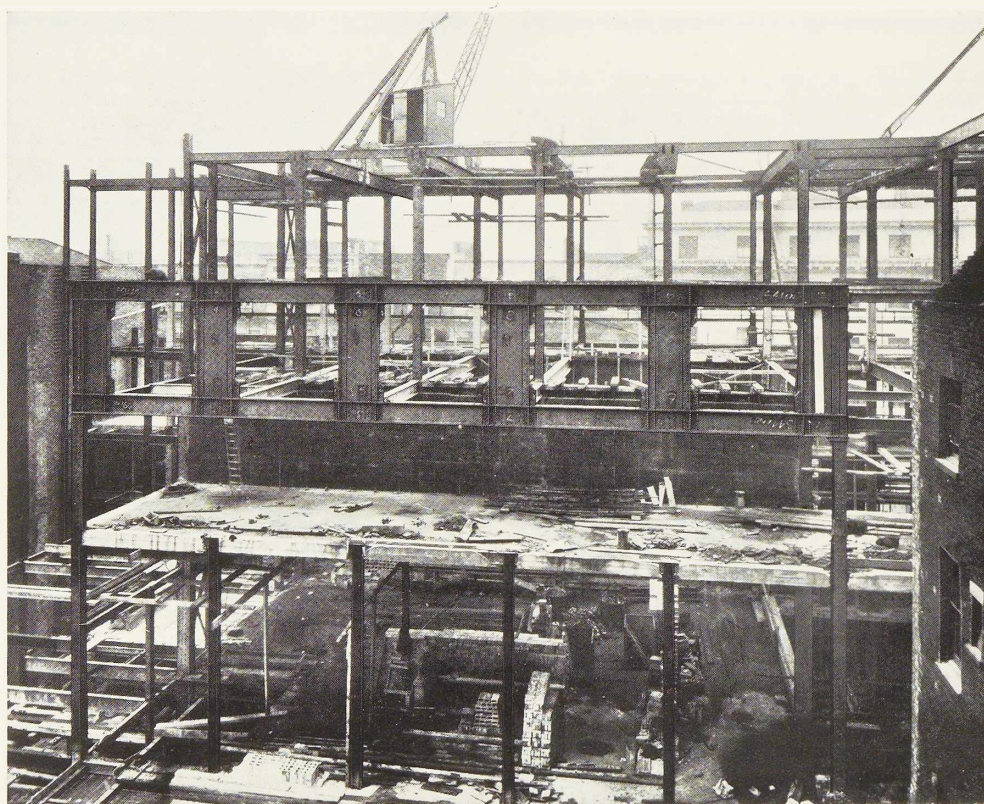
Poutre Vierendeel de 17^m90 de portée du nouveau bâtiment de la R. I. B. A. à Londres.
